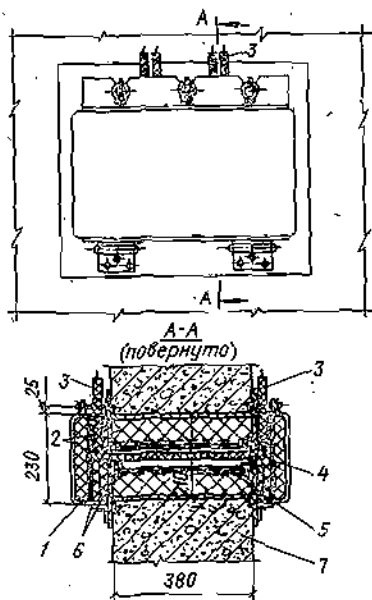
Звукоизолирующий коллектор для прохода электропроводов через стену или перекрытие
